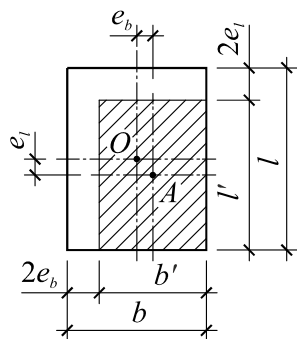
Схема к определению приведенных размеров подошвы фундамента:
